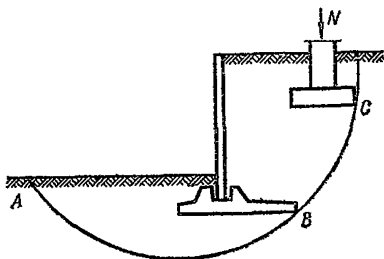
Схема потери устойчивости основания системы «подпорная стенка — фундамент» примыкающего сооружения
